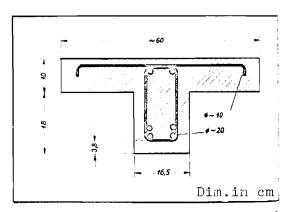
Brandversuche an Stahlbetan-Plattenbalken aus verschiedenen schlagstoffen (28). Balkenquerschnitt
